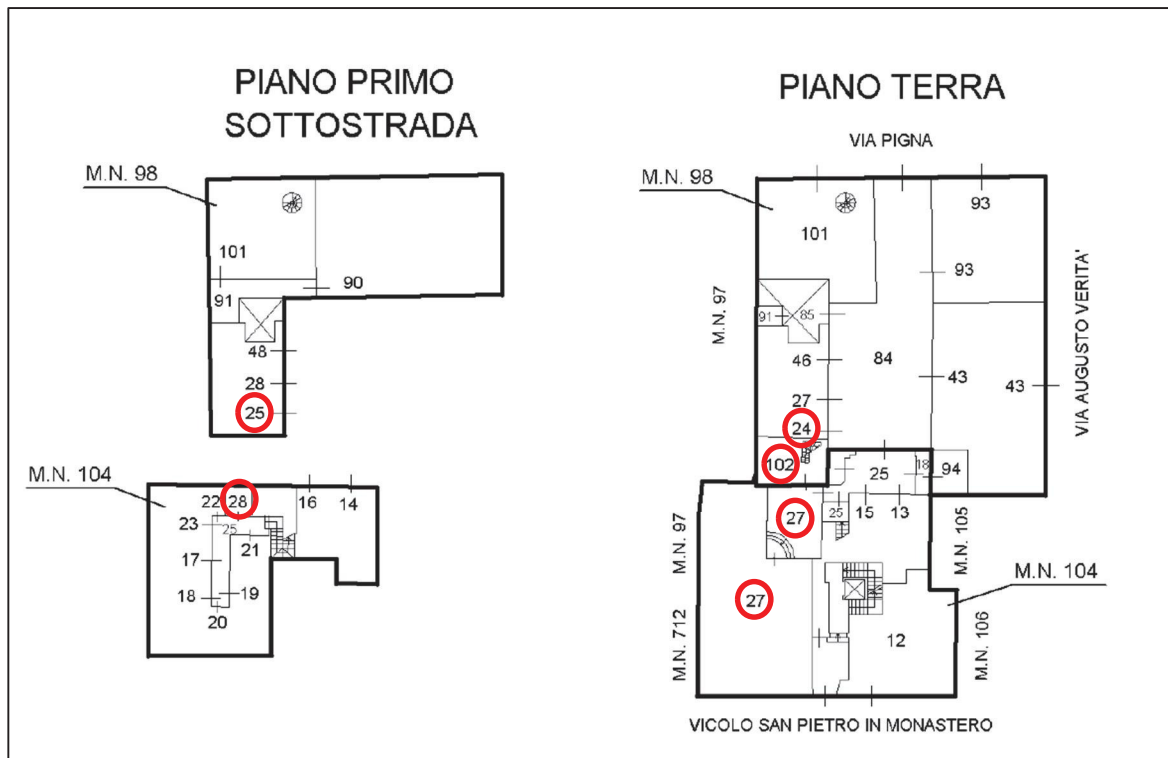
estratto del piano sottostrada e terra dell'elaborato planimetrico della particella 98-104
